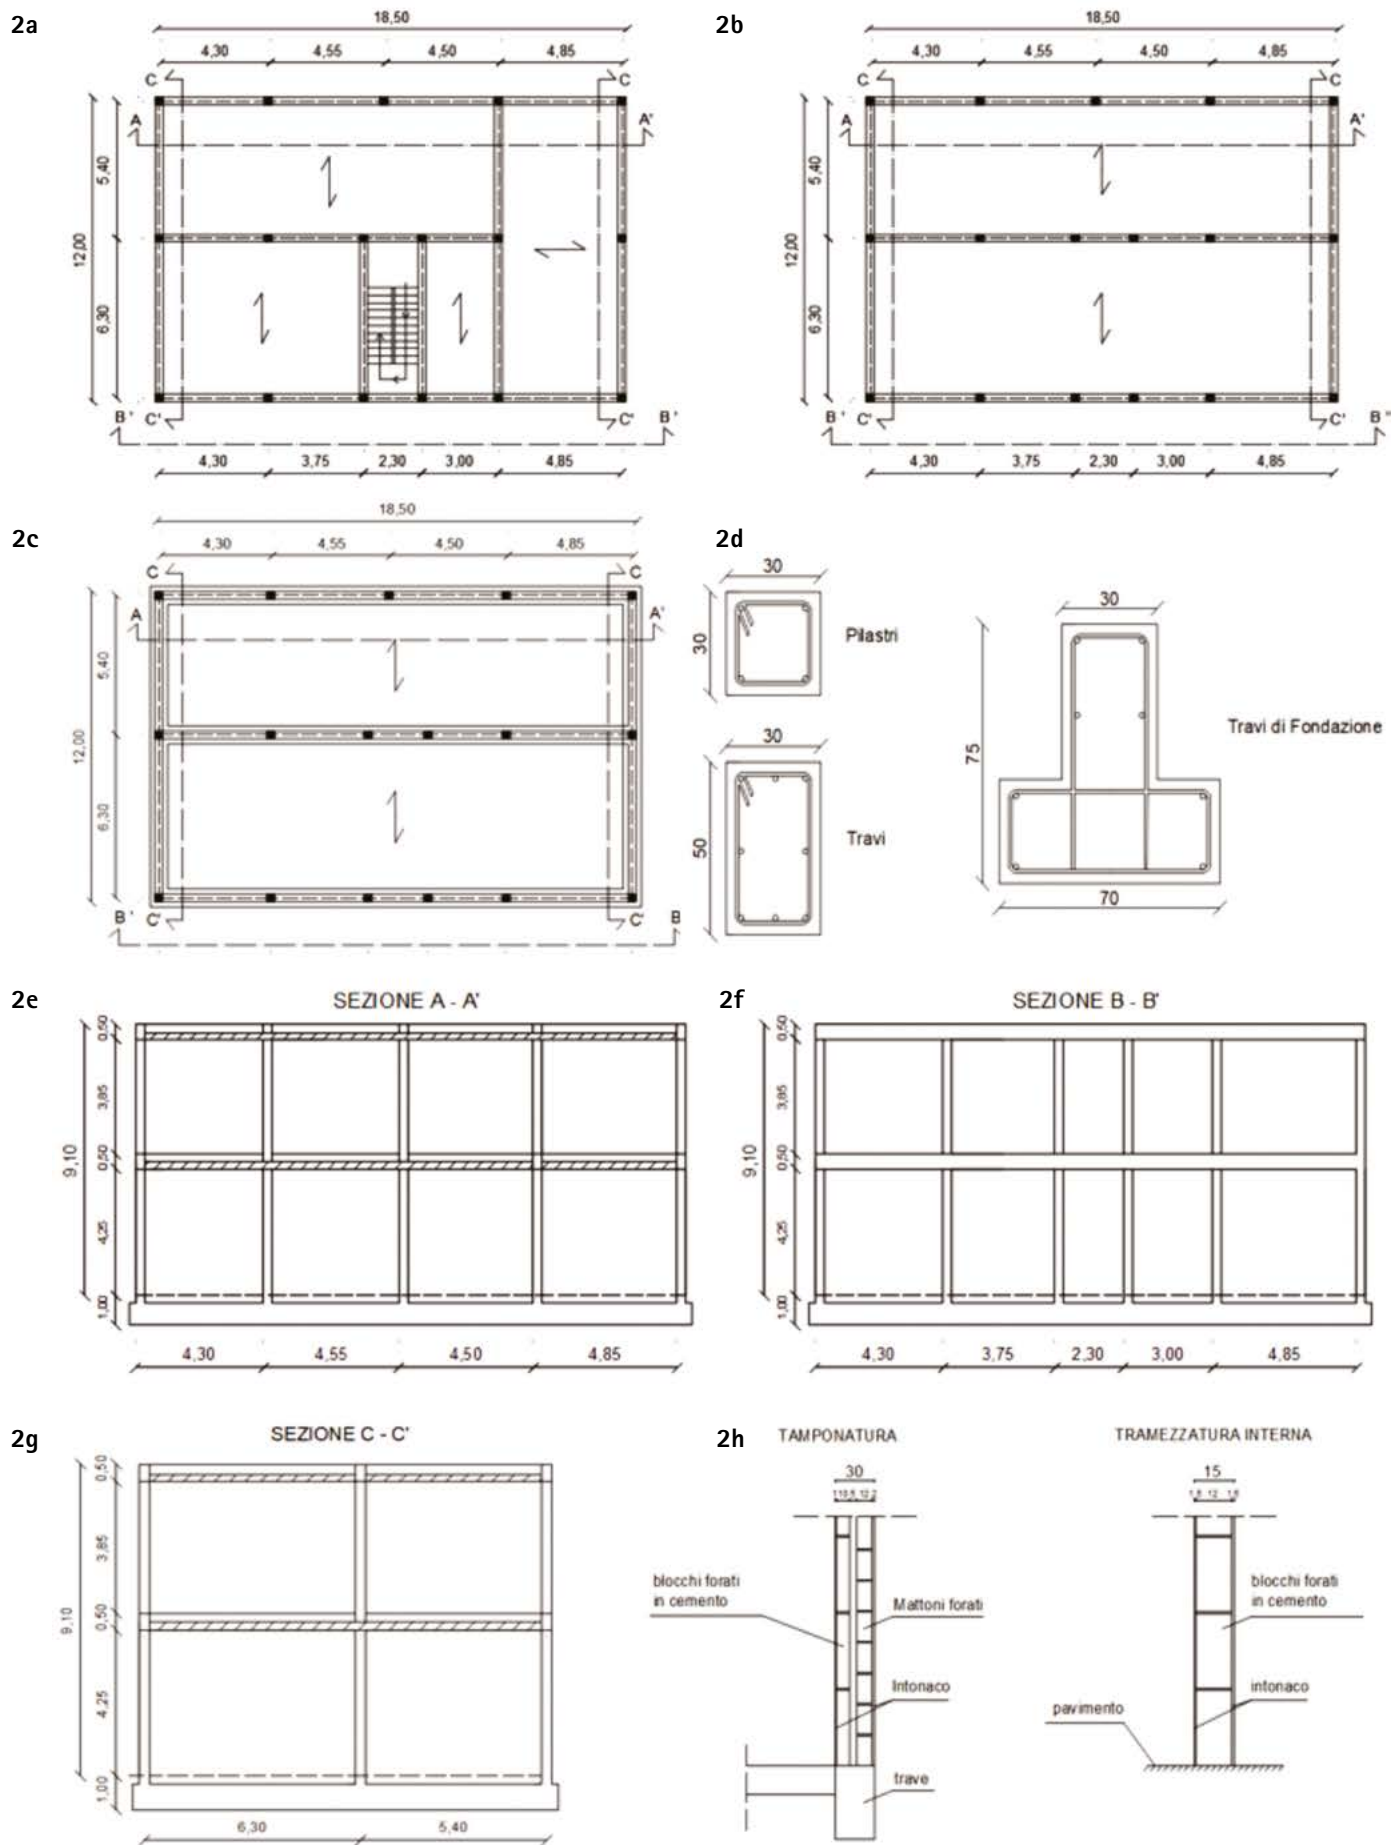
a) piano impalcato; b) secondo impalcato; c) pianta fondazioni; d) sezioni trasversali; e) sezione longitudinale A-A'; f) vista longitudinale B-B'; g) sezione trasversale C-C'; h) dettagli tamponatura e tramezzatura.
